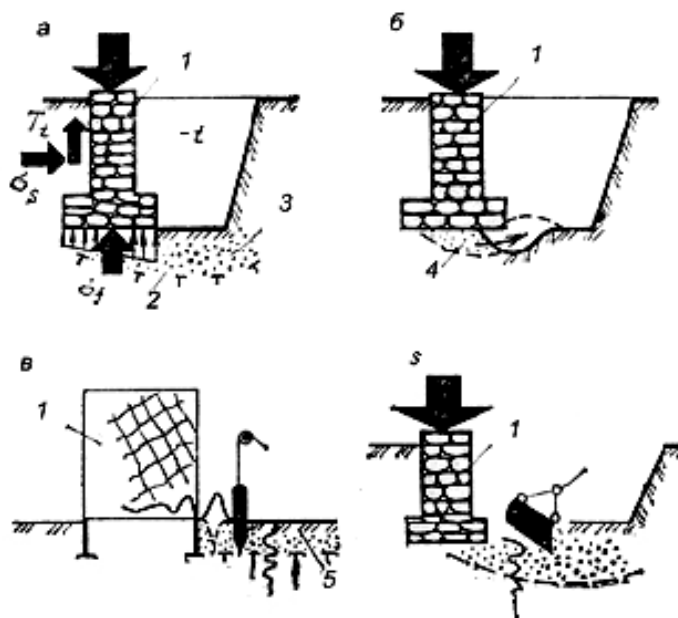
Нарушение естественного состояния грунта при производстве работ по устройству фундаментов: а – промораживание грунта; б – перебор грунта; в, г – динамическое воздействие механизмов: 1 - существующий фундамент; 2 – граница сезонного промерзания грунта; 3 – мерзлый грунт; 4 – выдавливание грунта; σ_s и σ_f - нормальные напряжения по боковой поверхности и по подошве фундамента; T_t - суммарная касательная сила выпучивания
